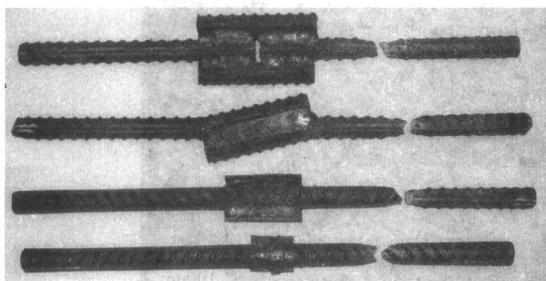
四种电弧焊接头拉伸试件
